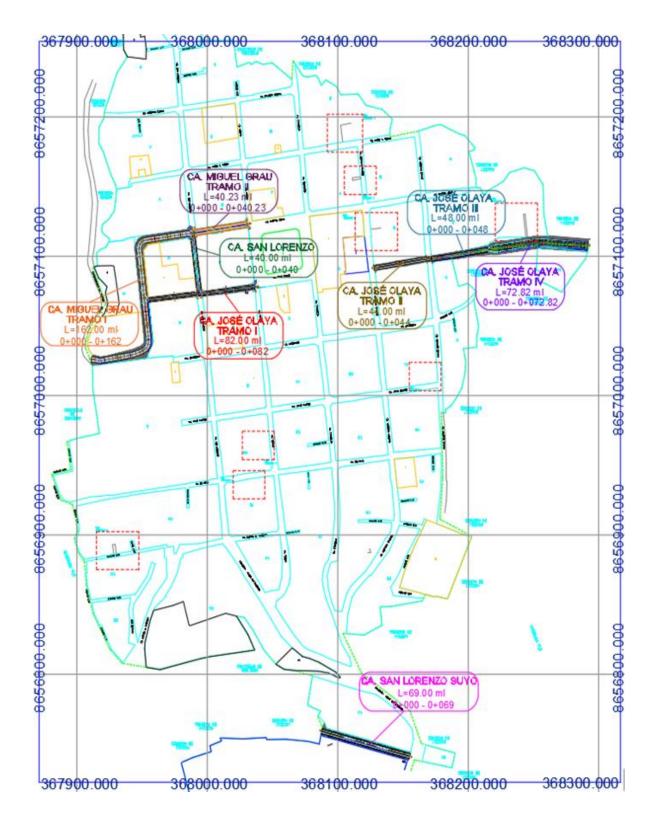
Plano de la Propuesta Técnica.
